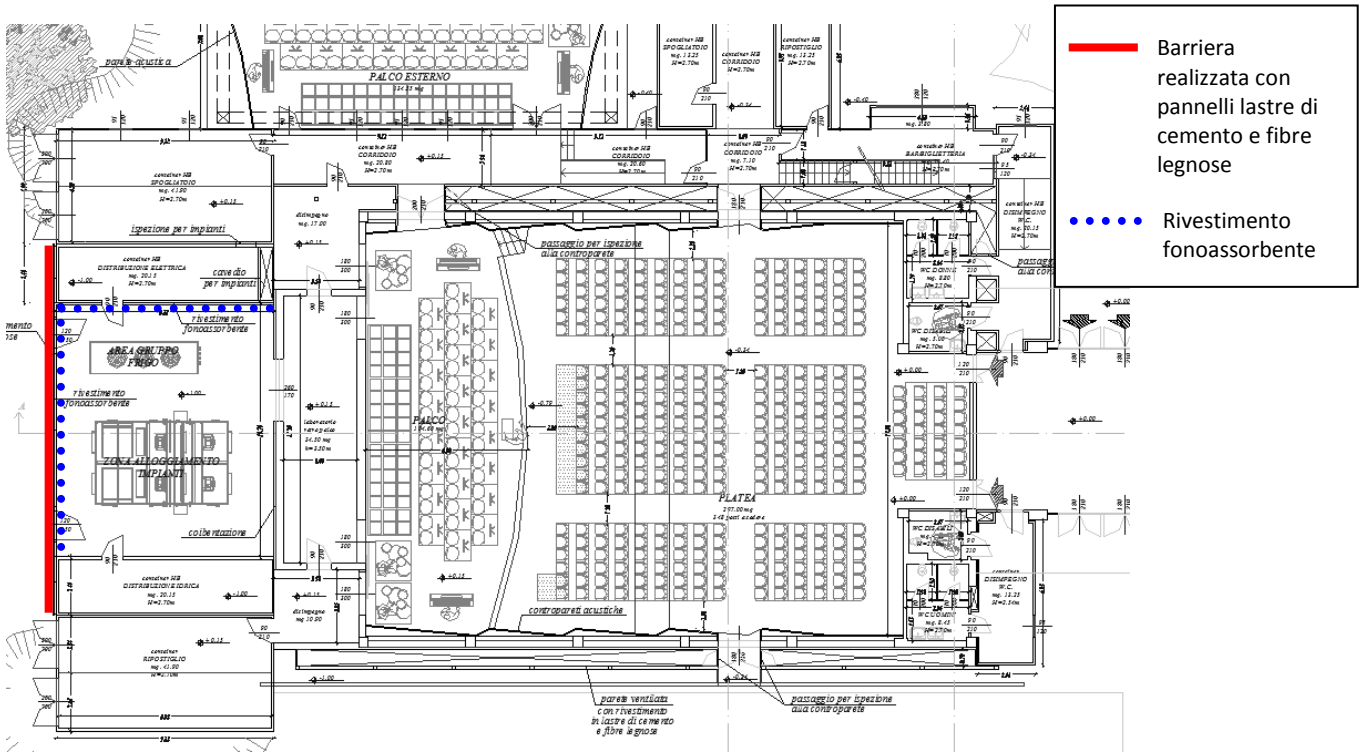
Prospetto della barriera fonoisolante/fonoassorbente
